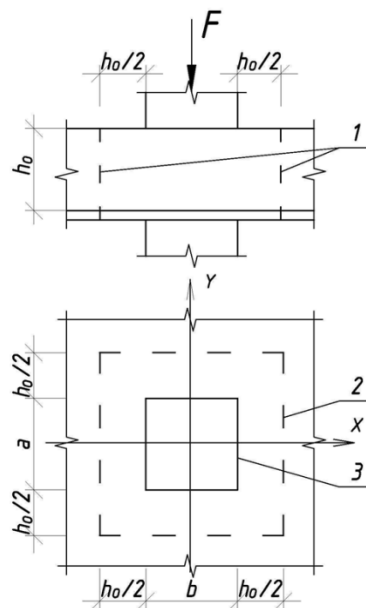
Схема для расчета железобетонных элементов без поперечной арматуры на продавливание
